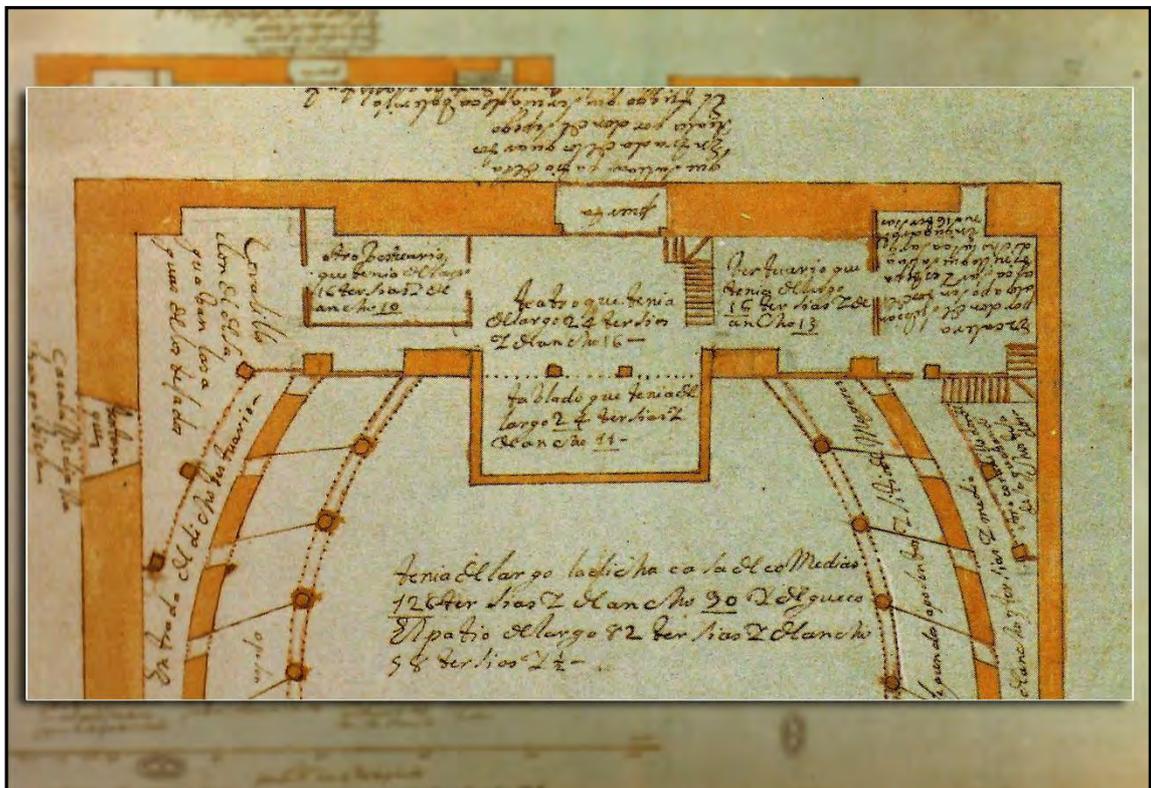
Plano de planta de Simancas, detalle de la zona del «teatro» (Ibidem).
